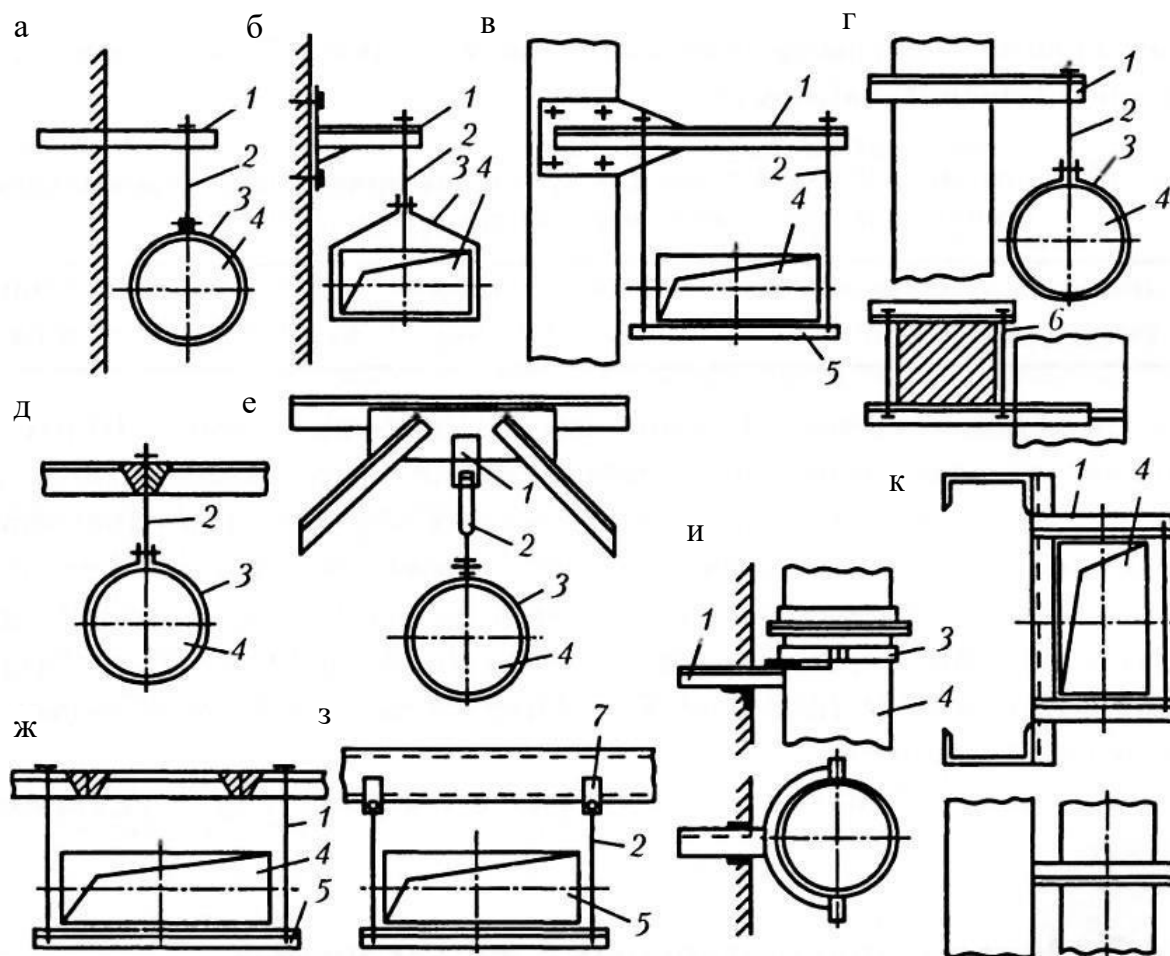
Схемы крепления круглых и прямоугольных воздуховодов:
